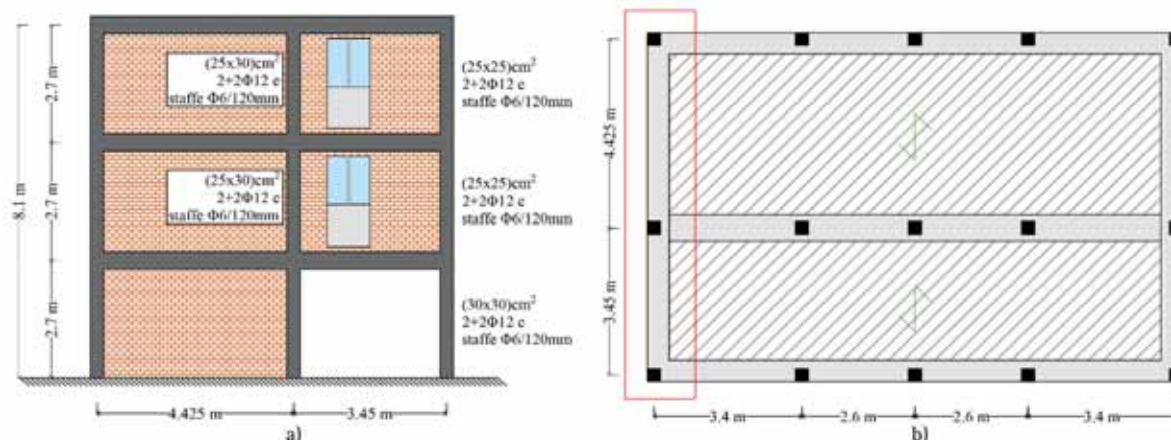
| a) Prospetto del telaio di riferimento e b) Pianta dell'edificio.
